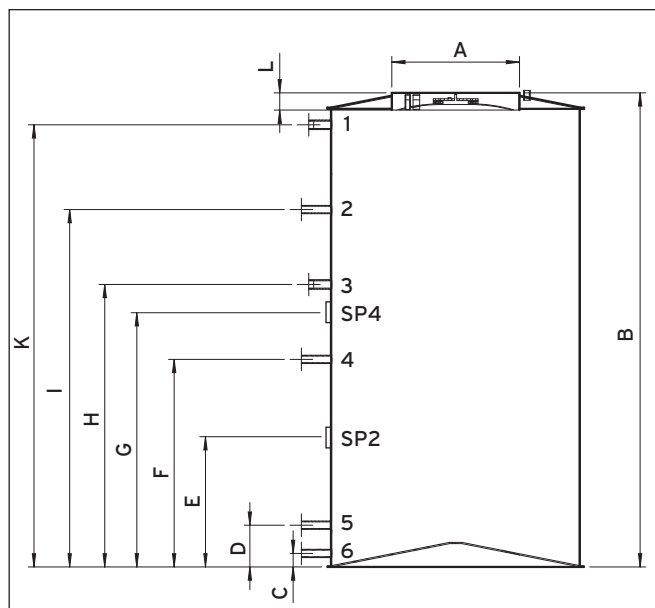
Dimensions de raccordement du ballon combiné auroSTOR VPS SC 1000, vue
